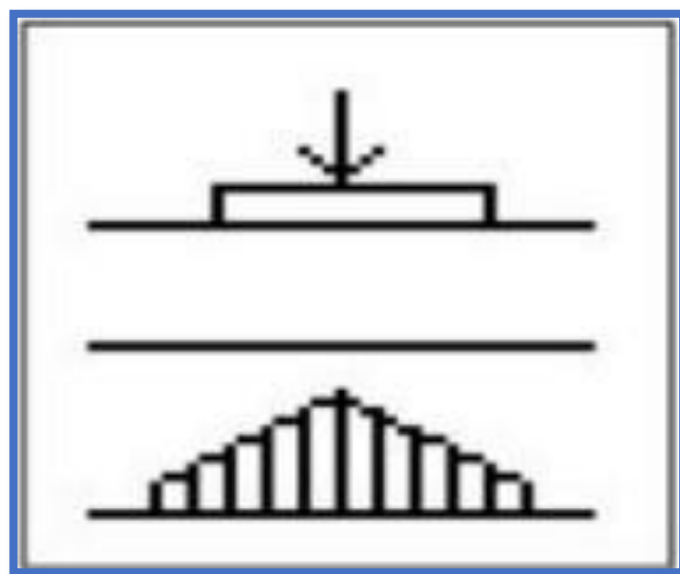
Distribución de esfuerzos de un Pavimento Flexible
